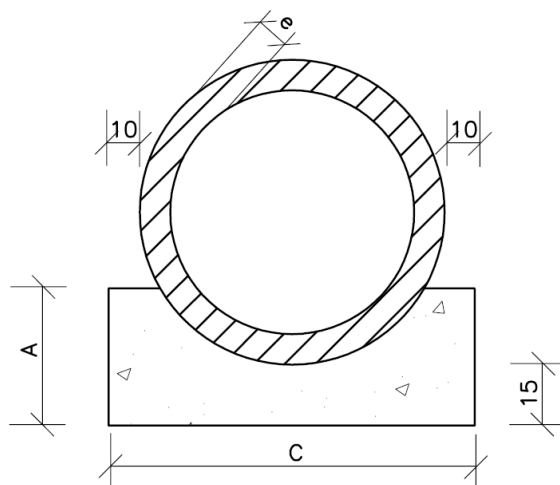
Bueiro Simples Tubular de Concreto (BSTC)
